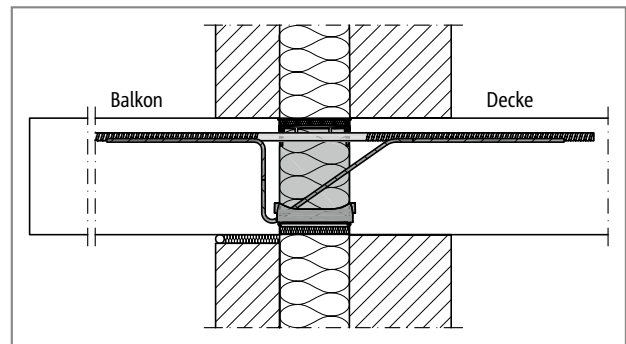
Schöck Isokorb® CXT Typ K: Anschluss bei zweischaligem Mauerwerk mit Kerndämmung
